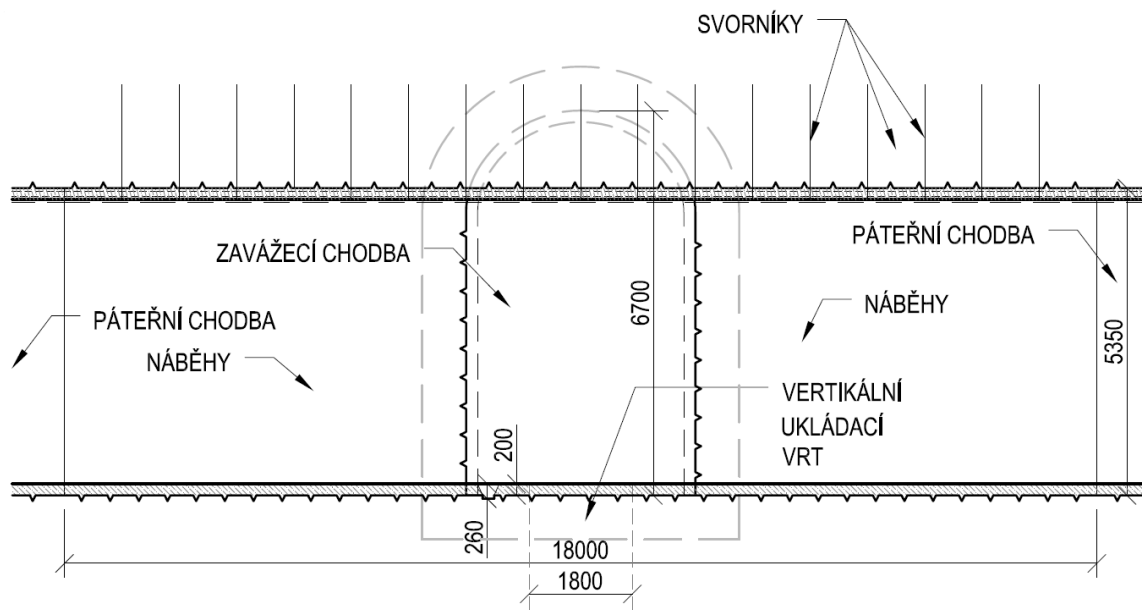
Půdorysné schéma ukládání – varianta D2
